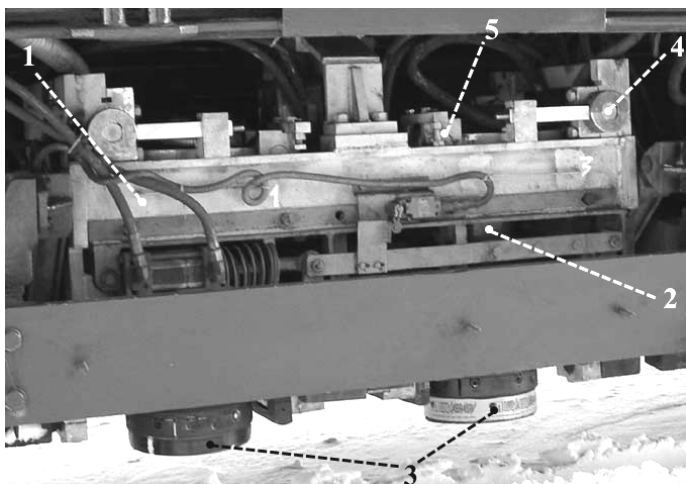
Общий вид рельсошлифовального блока опытного образца
